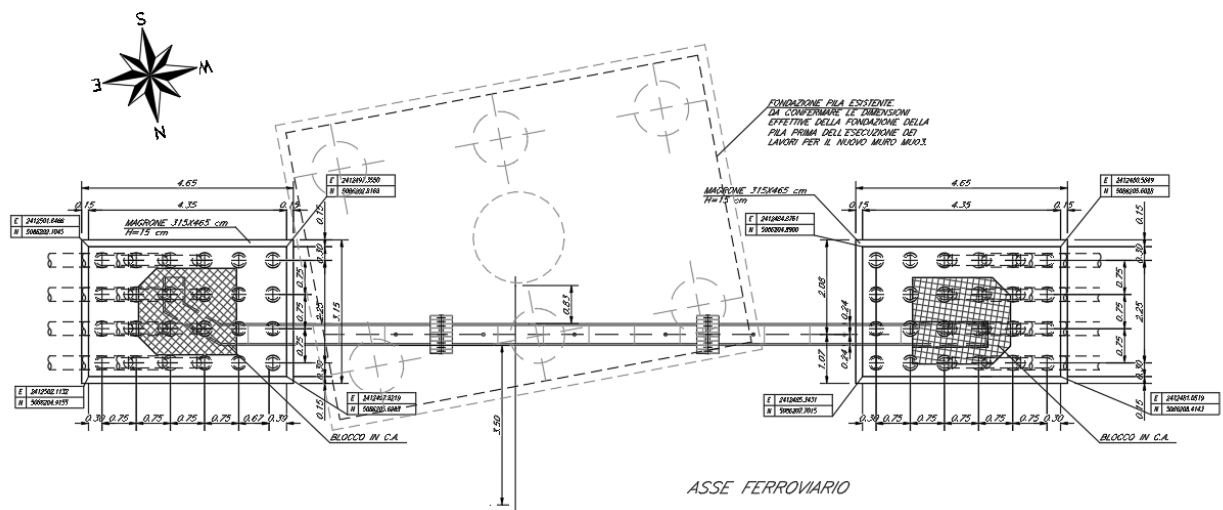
MU03 - planimetria generale muro opera di protezione con luce asse-asse di 17.00 m.
